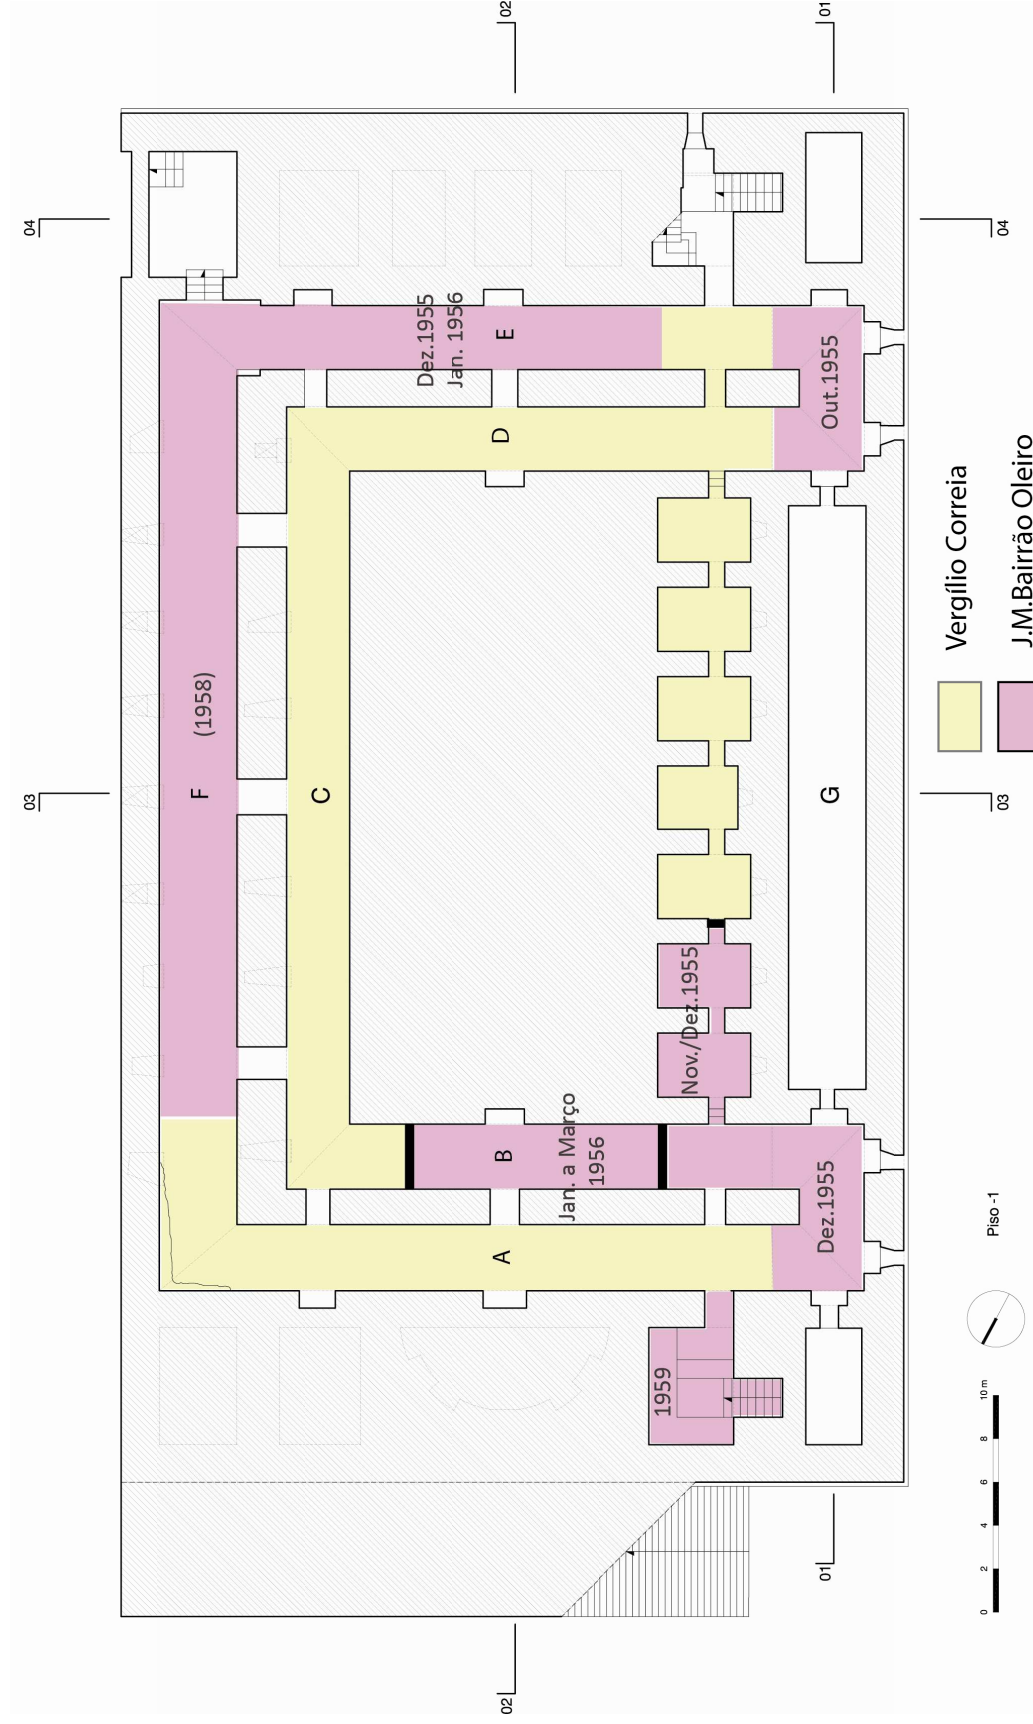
Planta do piso superior do criptopórtico – com indicação do faseamento dos trabalhos de escavação.
